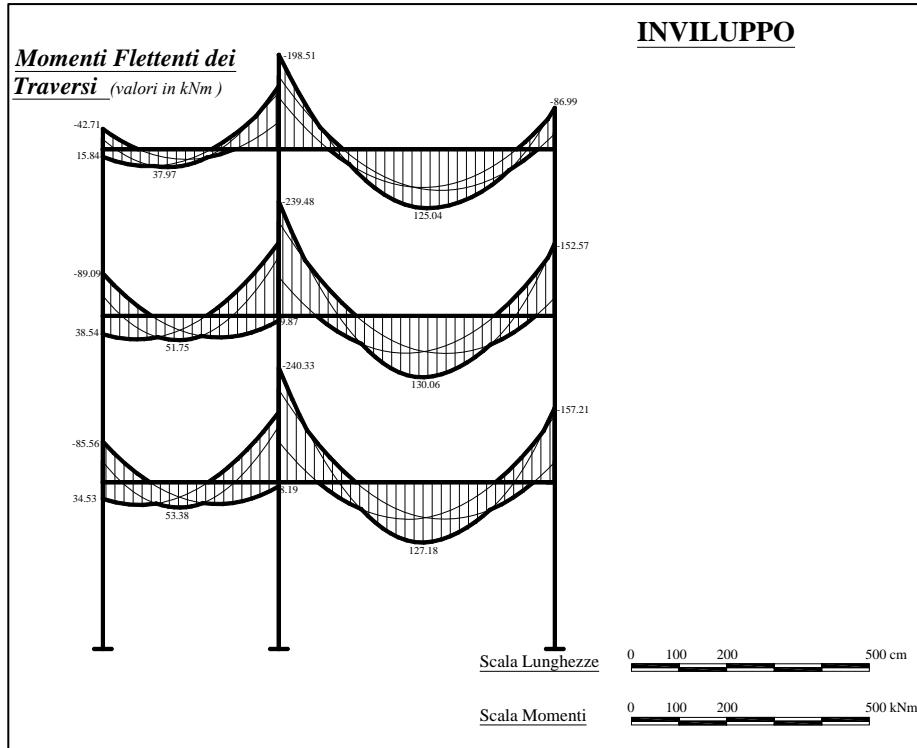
\_Stralcio elaborato 2. Inviluppo delle sollecitazioni flettenti nei traversi.
